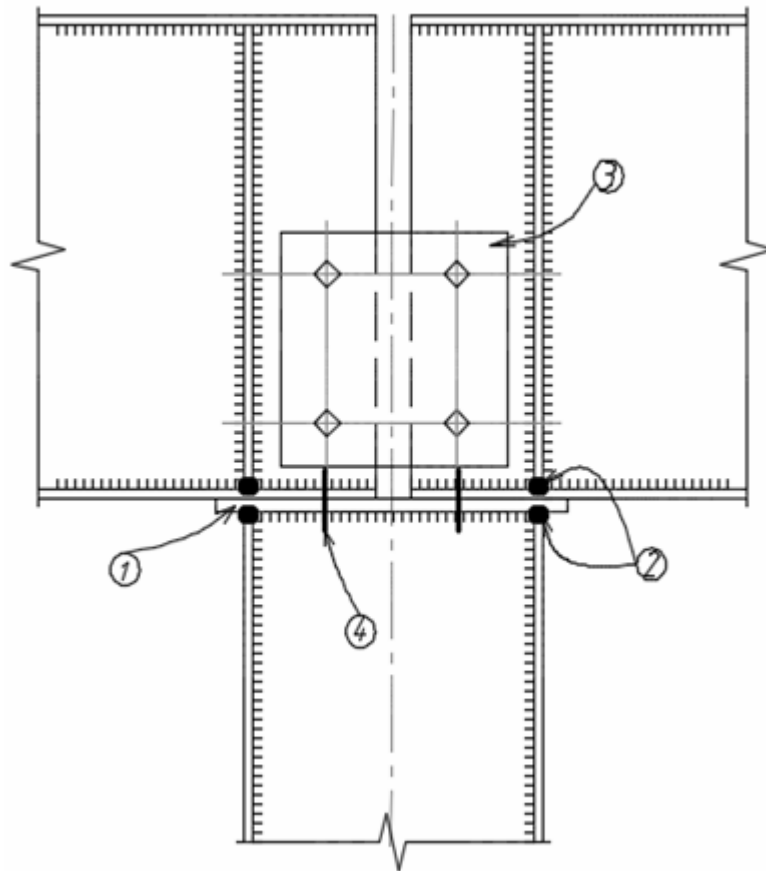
Оголовок зі зміщеними опорними ребрами (рис. 2.10, e):
